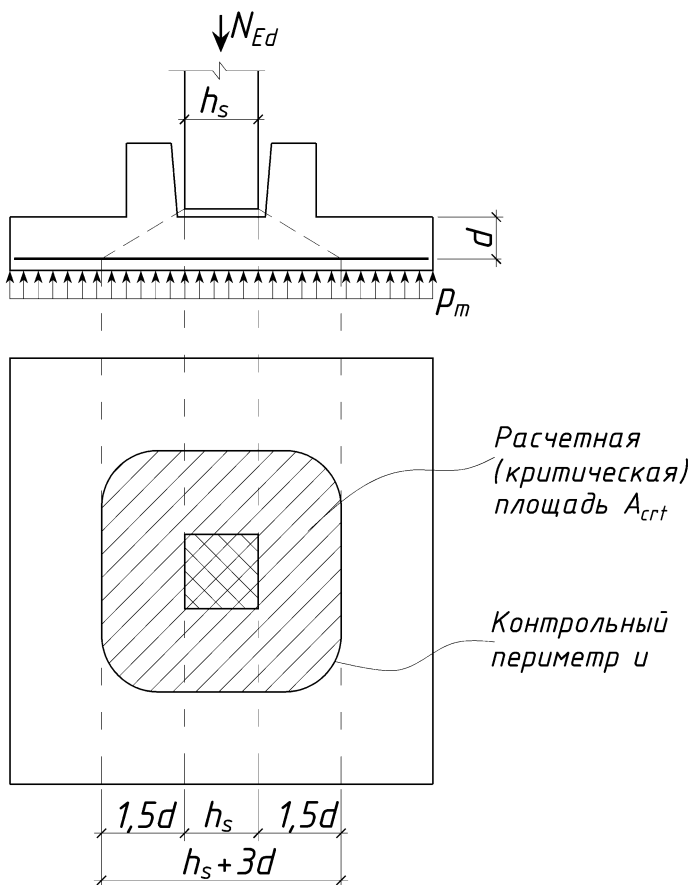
Расчетная схема фундамента при проверке на продавливание
